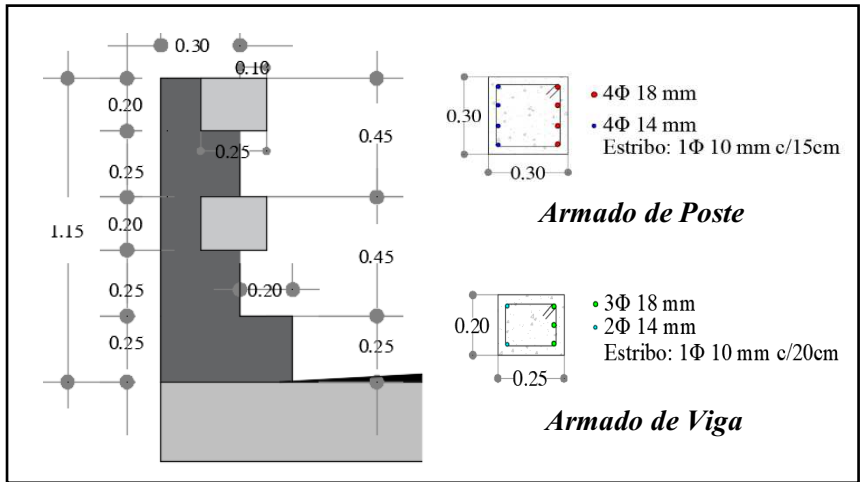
Dimensiones de la protección lateral poste – viga, corte transversal
